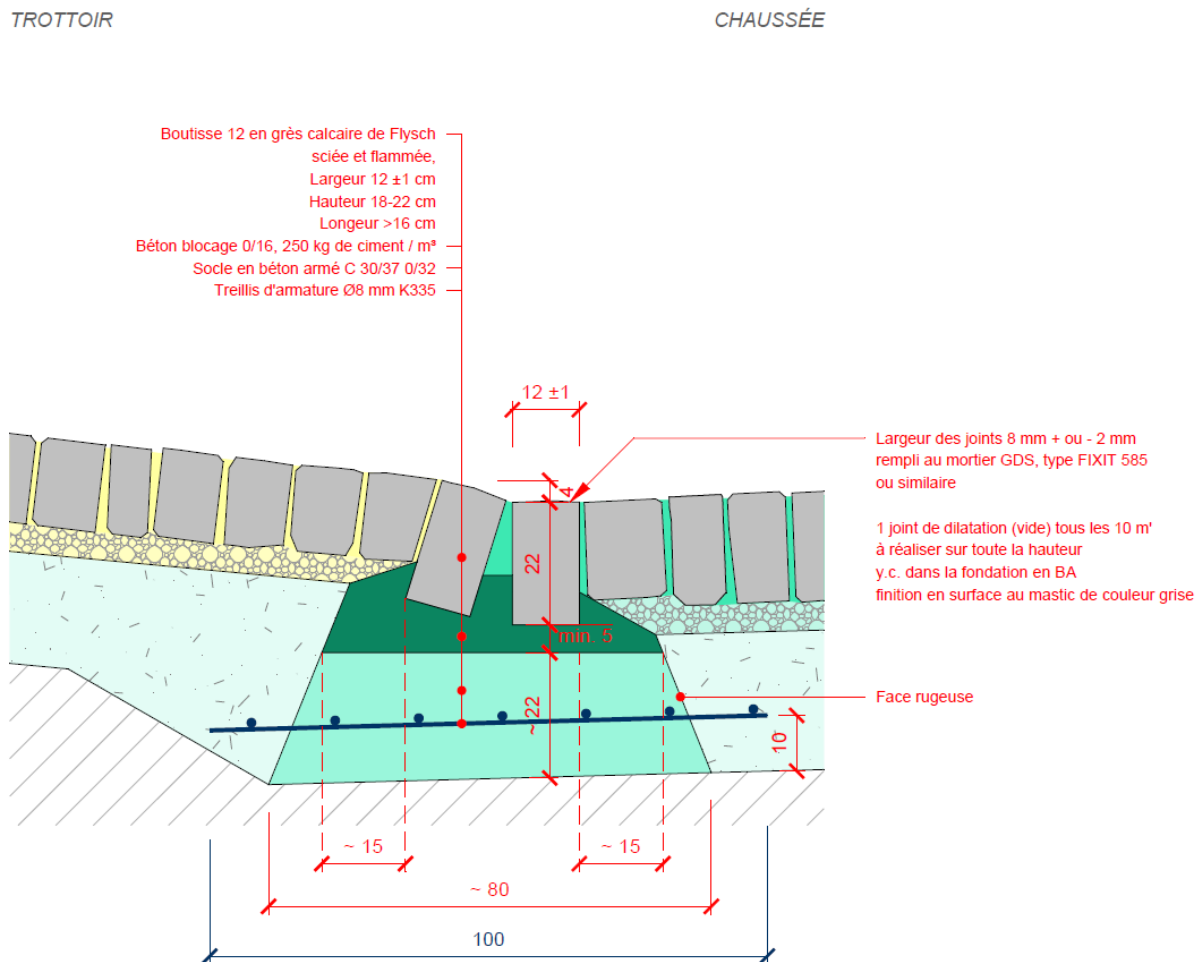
Détail bord de chaussée Tête de Pont côté Bourg
